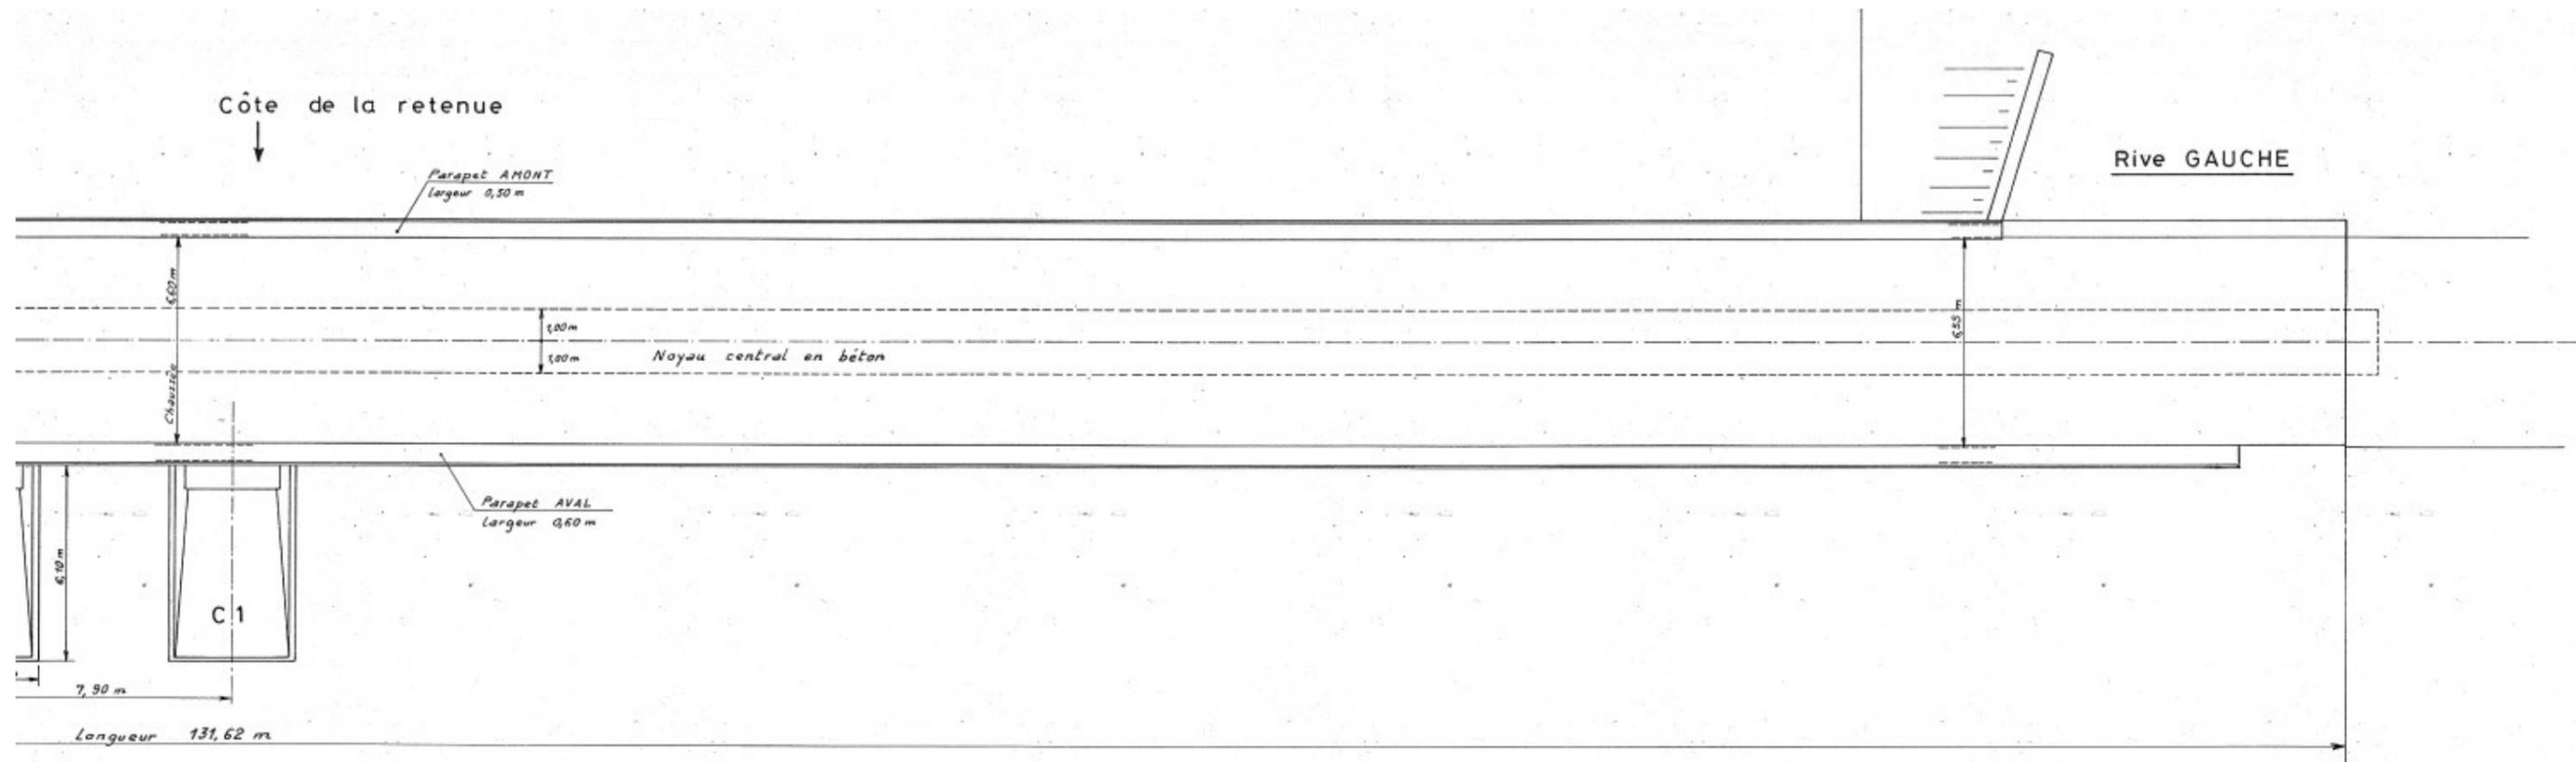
Zoom sur la partie rive gauche de l'ouvrage (source CETE 1987)
